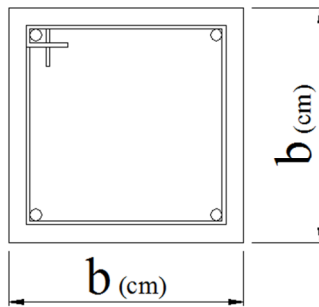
Detalhe da distribuição da armadura na seção transversal do pilar.
